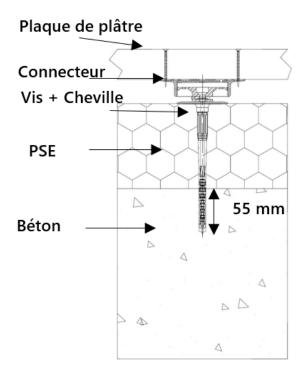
vue en coupe du schéma de montage : cheville, connecteur, isolant et plaque de plâtre
